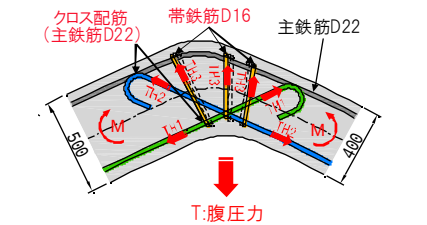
隅部配筋(クロス配筋＋帯鉄筋)
